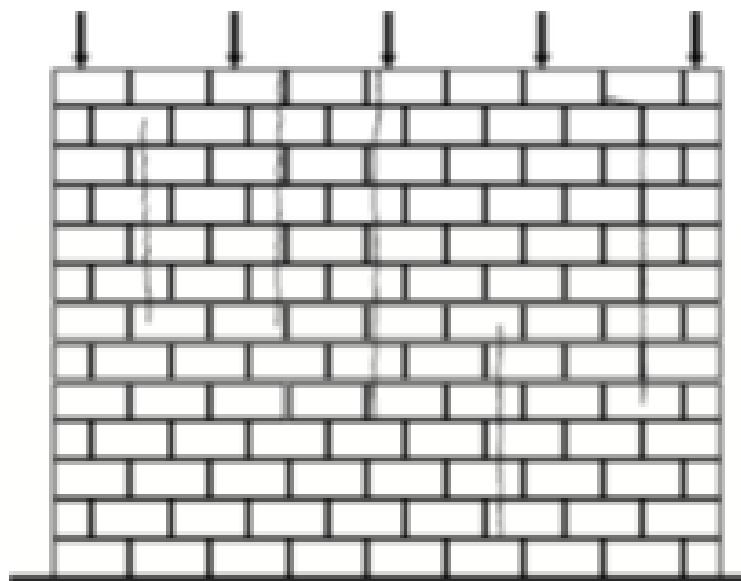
Fissuras verticais devido à sobrecarga de carregamento
